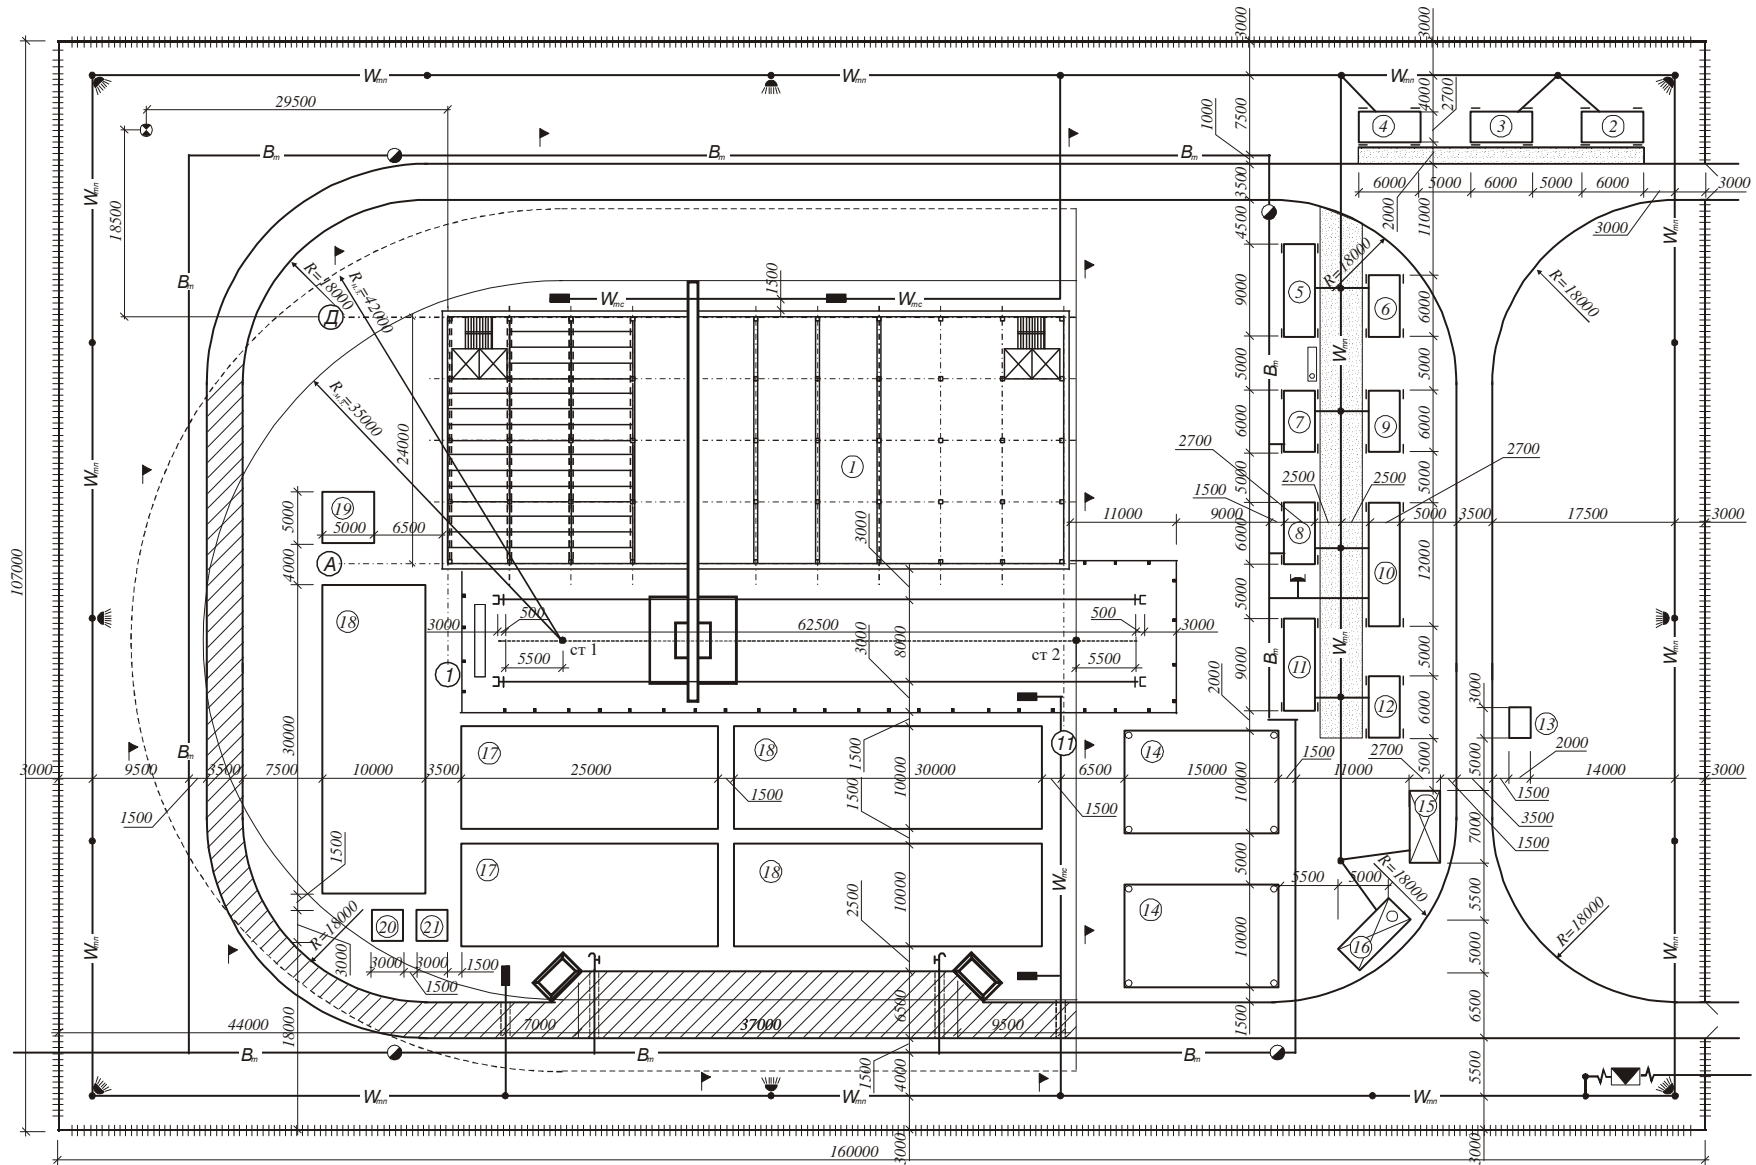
Будівельний генеральний план зведення виробничої триповерхової будівлі
